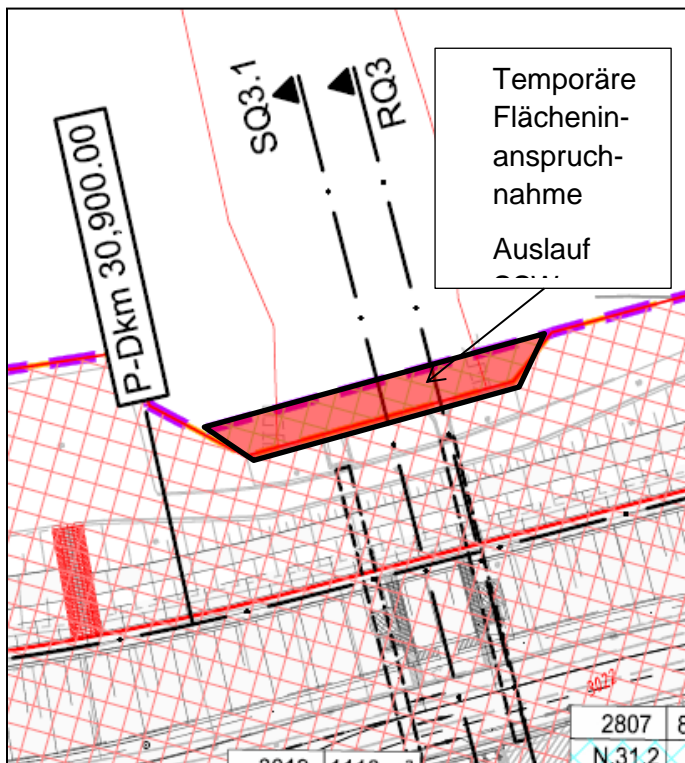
Ausschnitt aus Lageplan „Flächenbedarfsplan PFU 06\_N\_1“. Quelle: WKC
